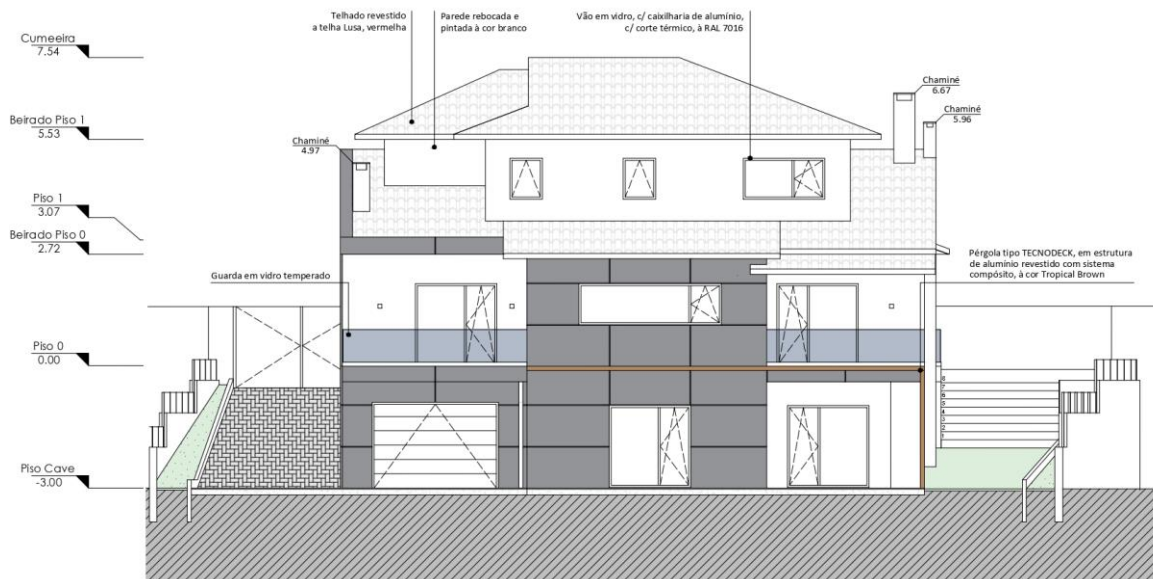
Proposto - Alçado posterior - vista poente (LIC_R00). Fonte: Garq / Desenvolvimento: Autora.
